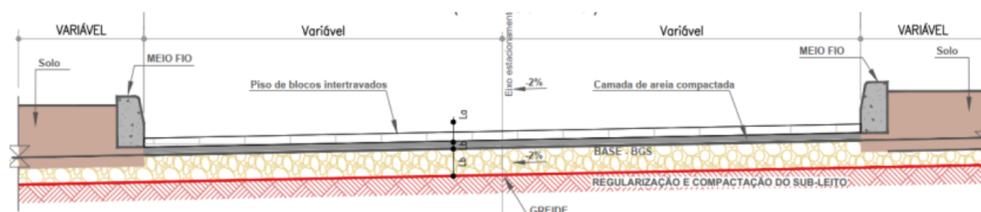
Seção tipo - Estacionamentos em Blocos Intertravados - Projeto de Pavimentação
